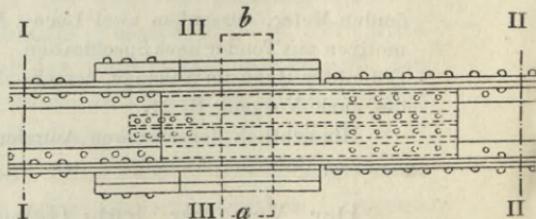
Grundriss zu Fig. 62 (1:25 nat. Grösse).
